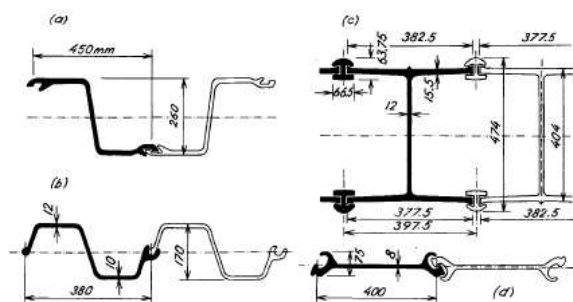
Perfis de seções diversas a) seção tipo “Z” - Belval Z-IIIIN; b) seção tipo “S” - Terre Rouge III e c) seção tipo “I” - Peine; d) seção tipo plana - Peine - (Bažant, 1979)
